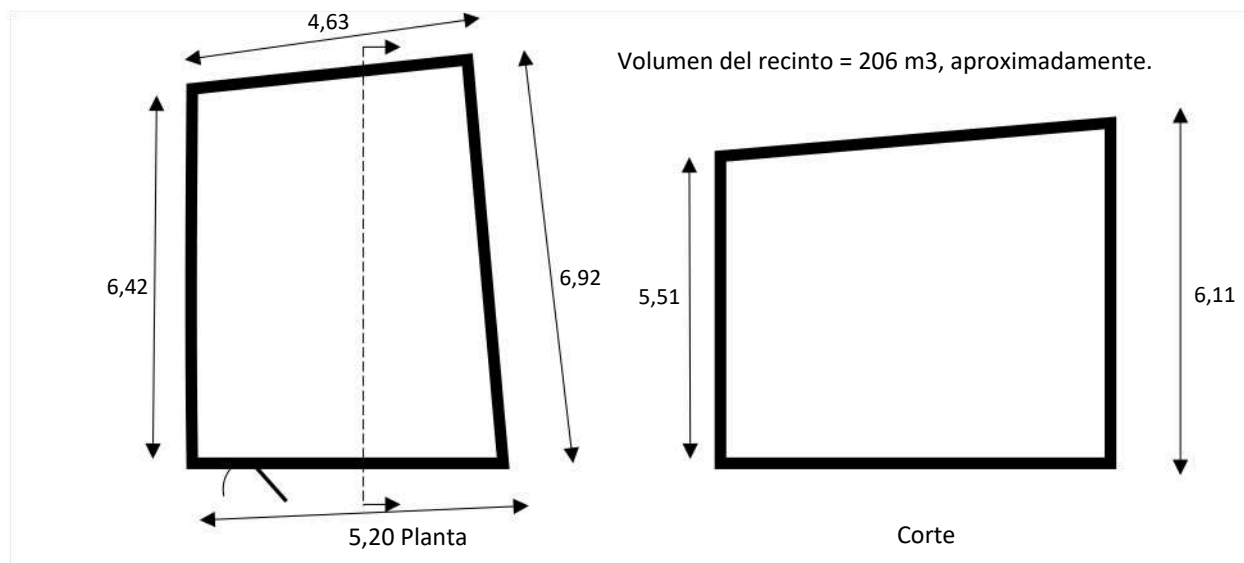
Esquema de planta y corte de los recintos de ensayo
